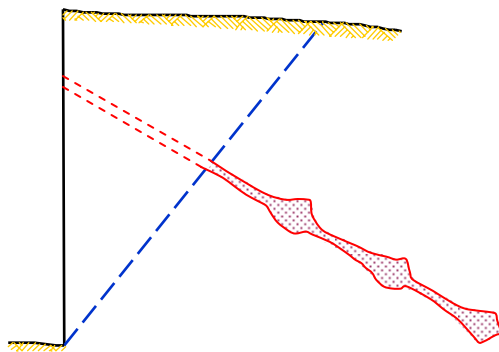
Zona de Anclaje y Zona Libre de Adherencia
